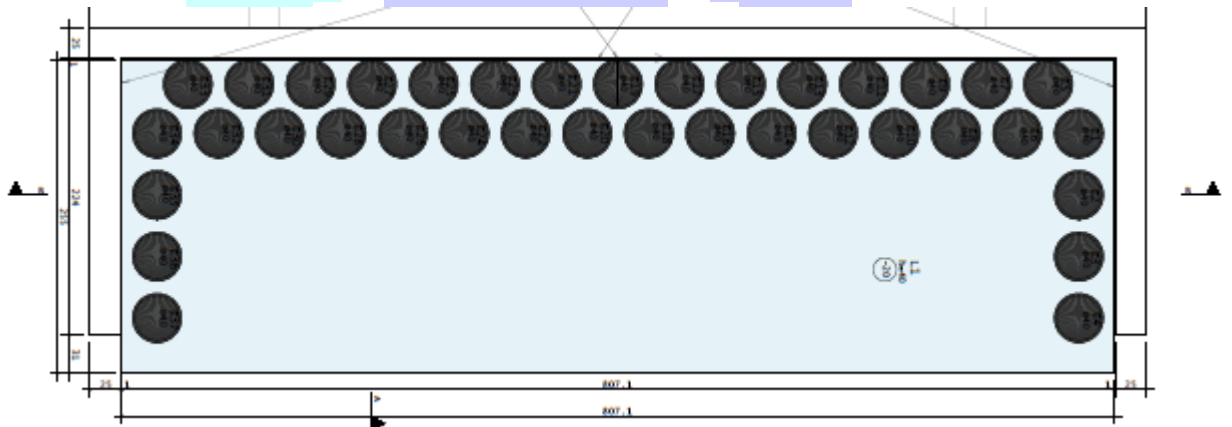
área de corte de asfalto e escavação, onde será executada a laje de transição
